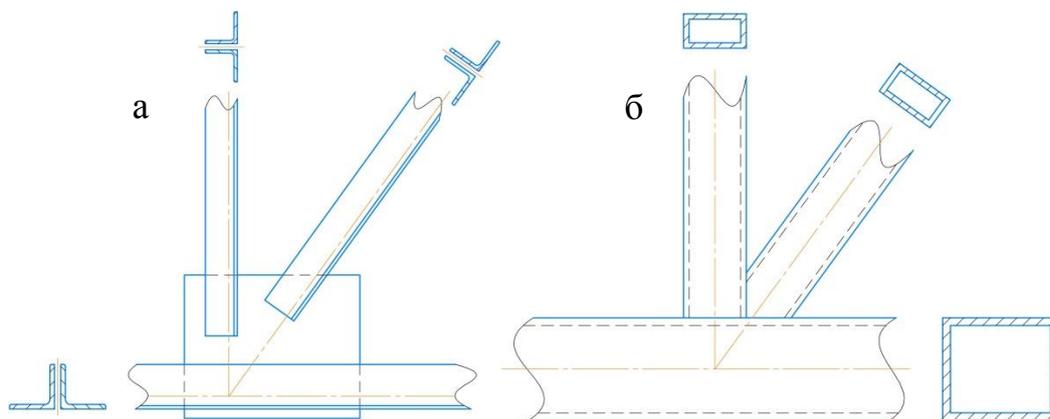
Узлы ферм: а – на фасонках; б - с примыканием элементов.
